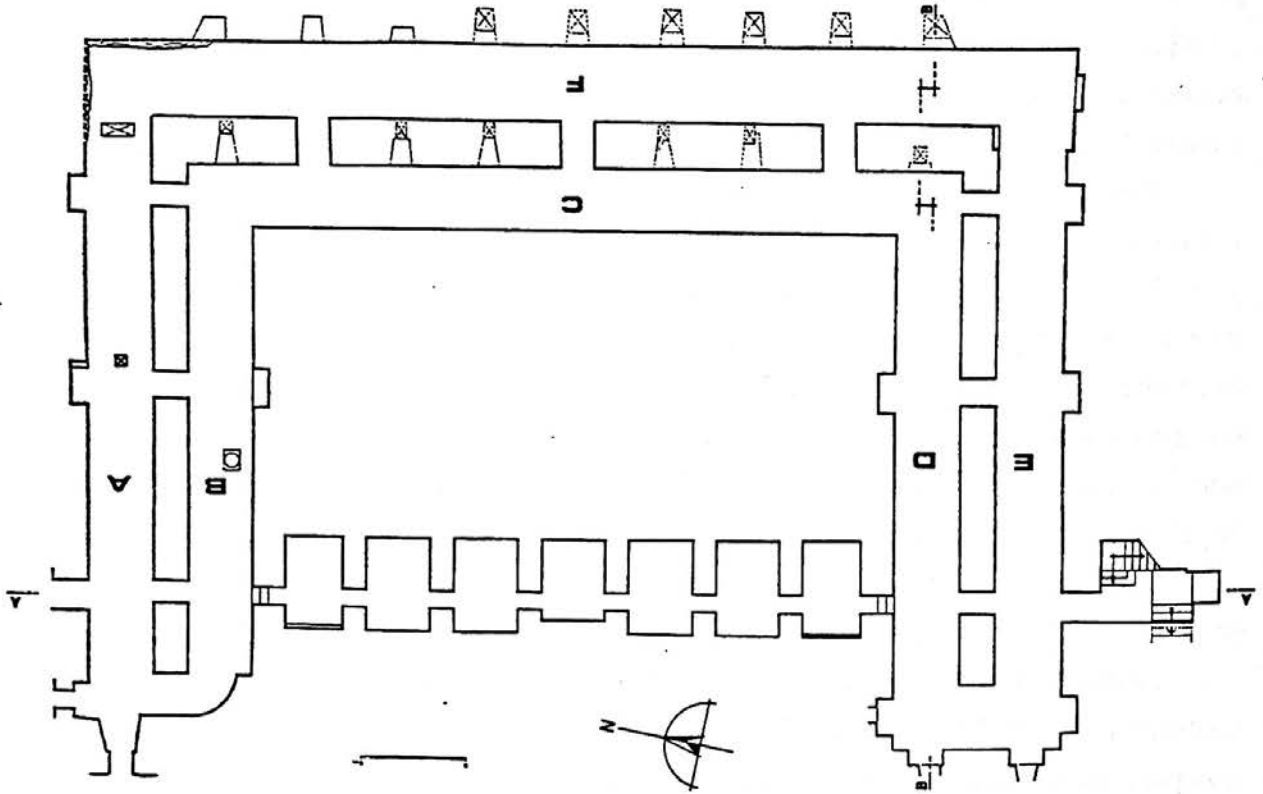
Planta del criptopórtico de *Aeminium*. —Según J. M. B. Oleiro y J. de Alarcão (1973).
